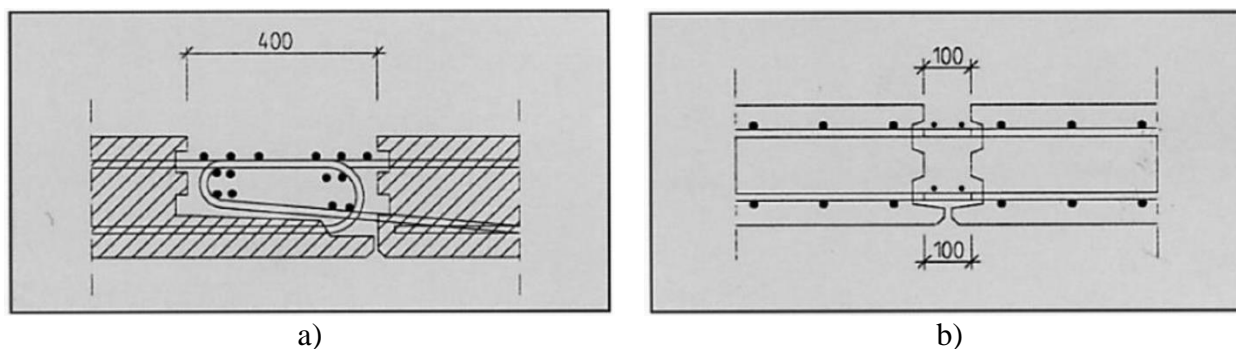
Exemples de joints coulés sur place : a) joint avec barres d'armature en U; b) joint avec barres d'armatures droites (Hansen & Jensen, 1999)
